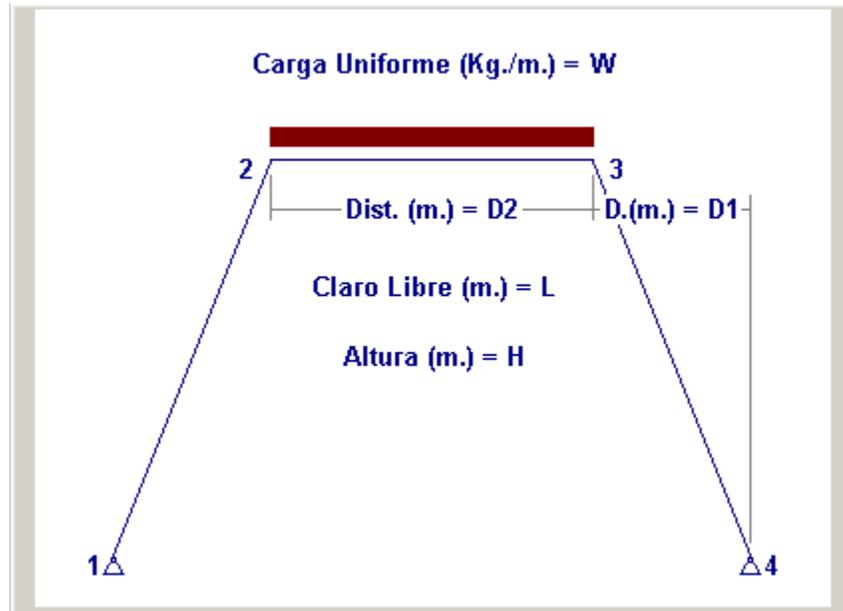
Vista de Marco Trapezoidal, Carga Uniforme
